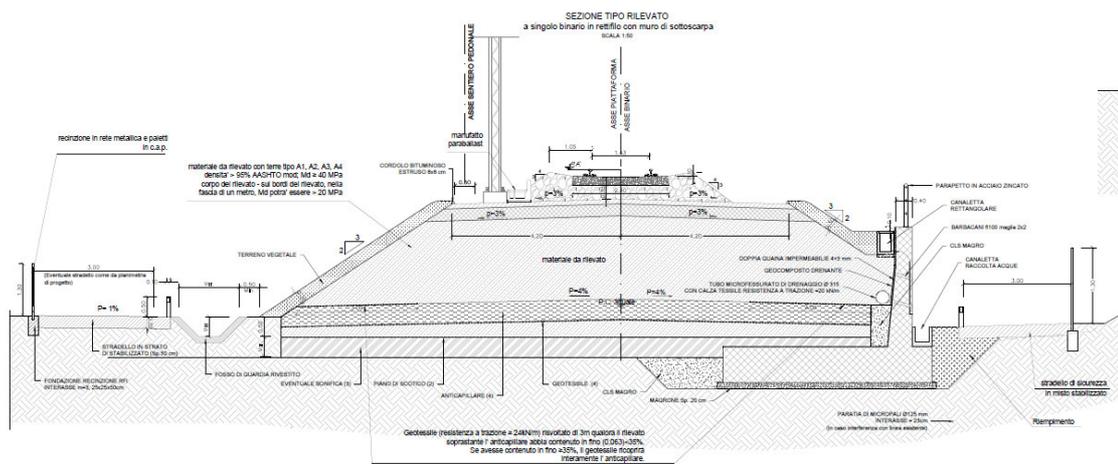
Corpo stradale ferroviario – Sezione tipo con muro di sottoscampa
